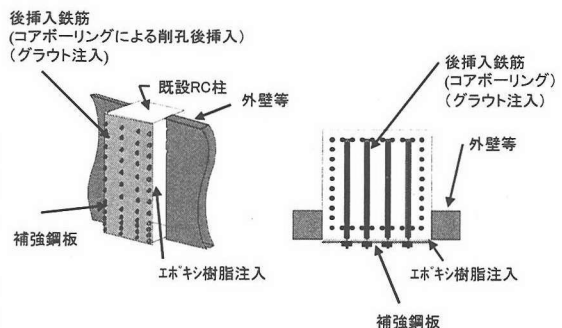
RC柱の一面から施工を行う耐震補強工法の概要
